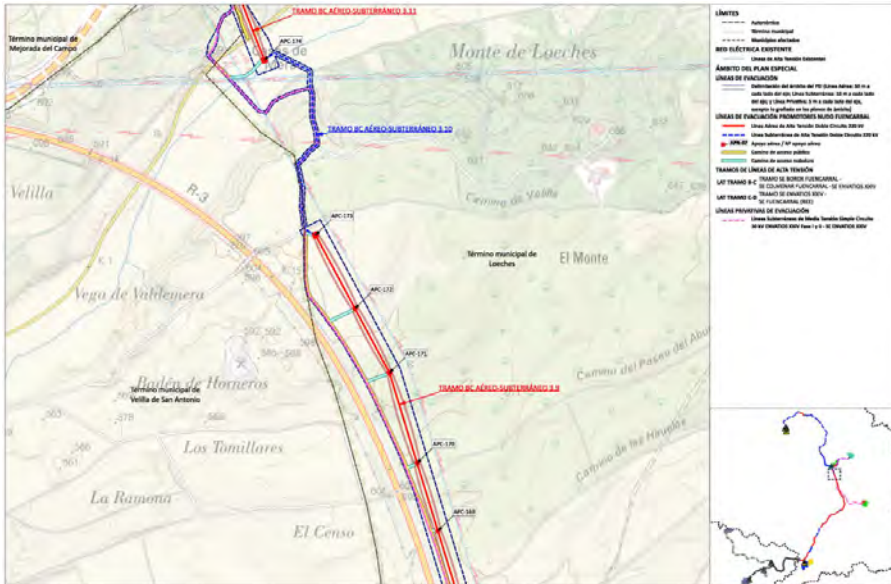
Plano de Ordenación O2.3.15. Planta por tramos. LASA Promotores Nudo Fuencarral Tramo B-C
